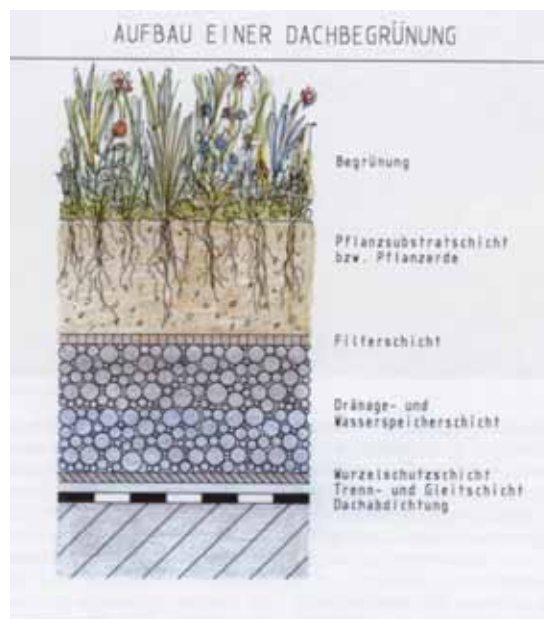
Schichtaufbau einer Dachbegrünung im Detail. © Fa. Optigrün
